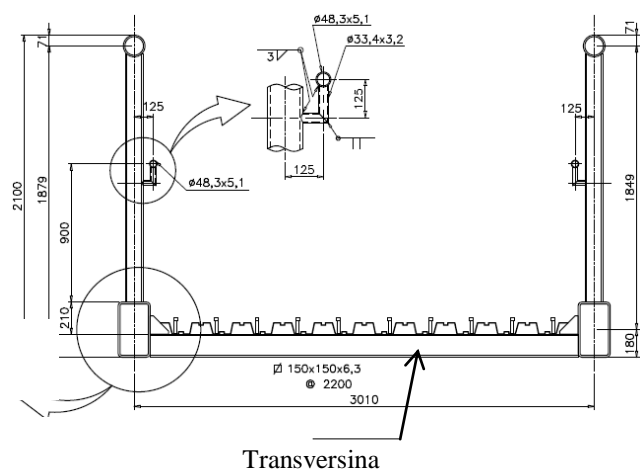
Seção transversal típica no vão caracteriza viga treliçada invertida do tipo *pony truss*.
